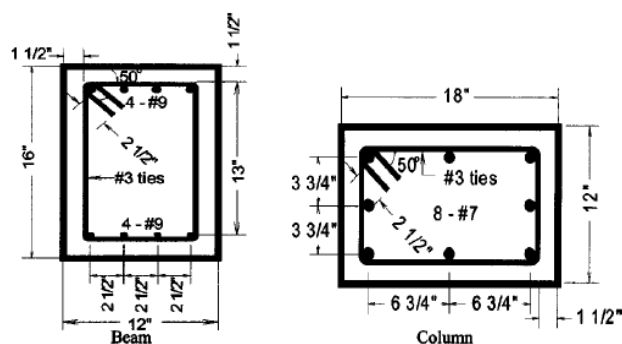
Sección viga/columna (Pantelides et al, 2003)
